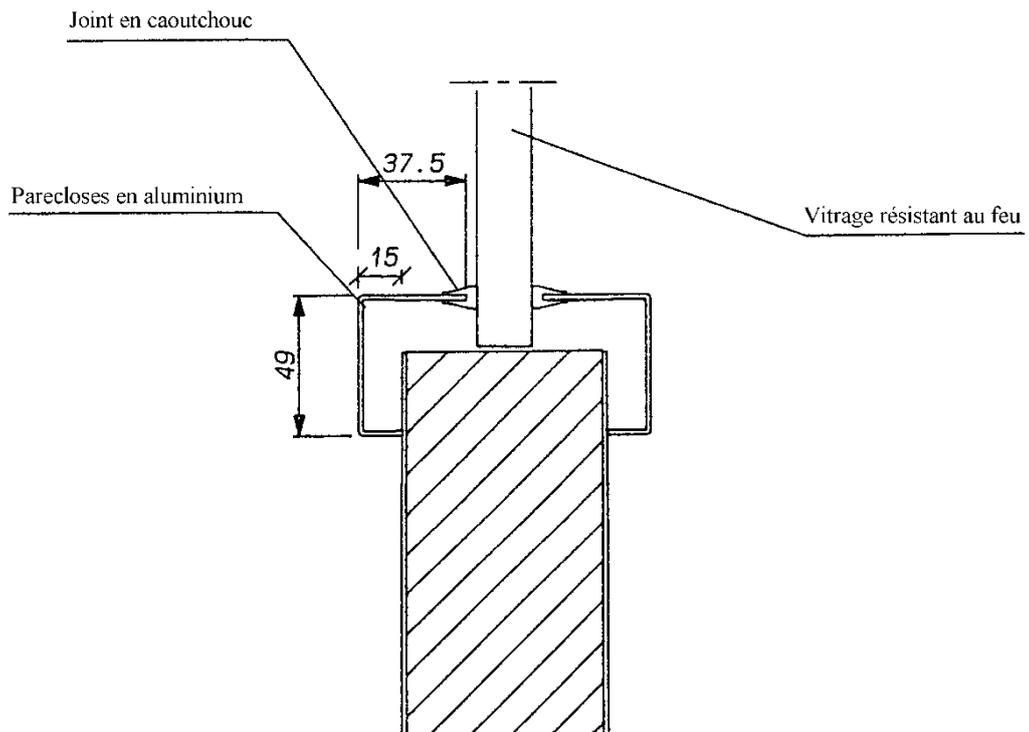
bis : Coupe du vantail à l'endroit des parecloses
